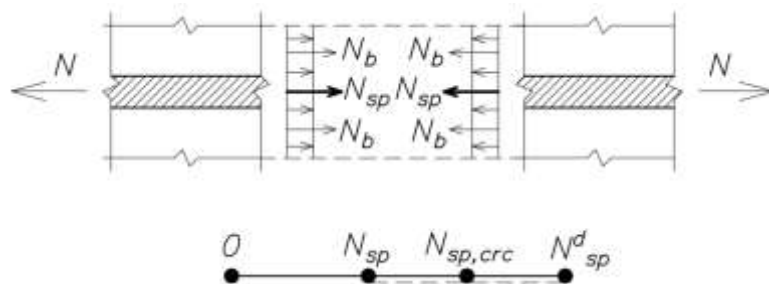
Схема статических и динамических усилий в предварительно напряженном железобетонном элементе в момент хрупкого разрушения бетона
